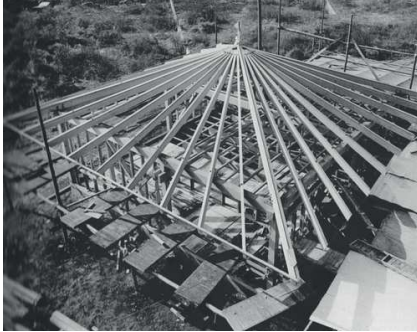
Estructura de la cubierta. Las viguetas de madera parecen emular un paraguas.
